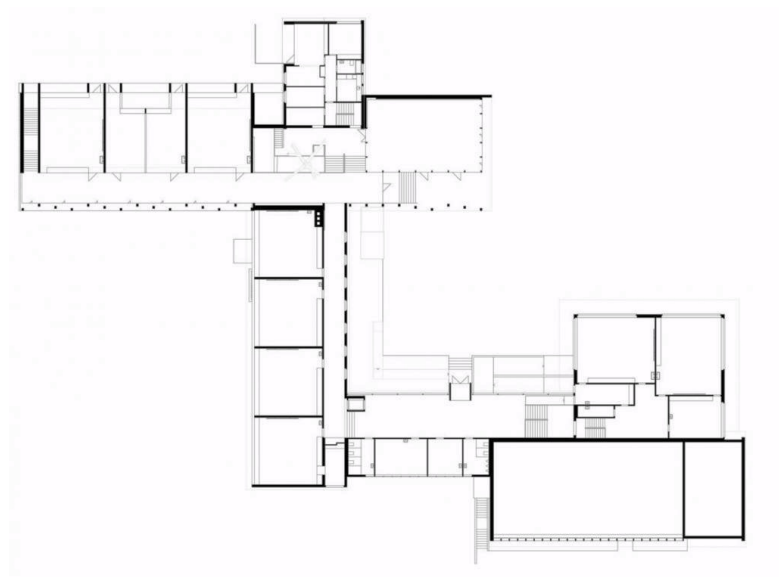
Grundrissplan, freier Massstab; Quelle: www.architekturpreis-beton.ch
